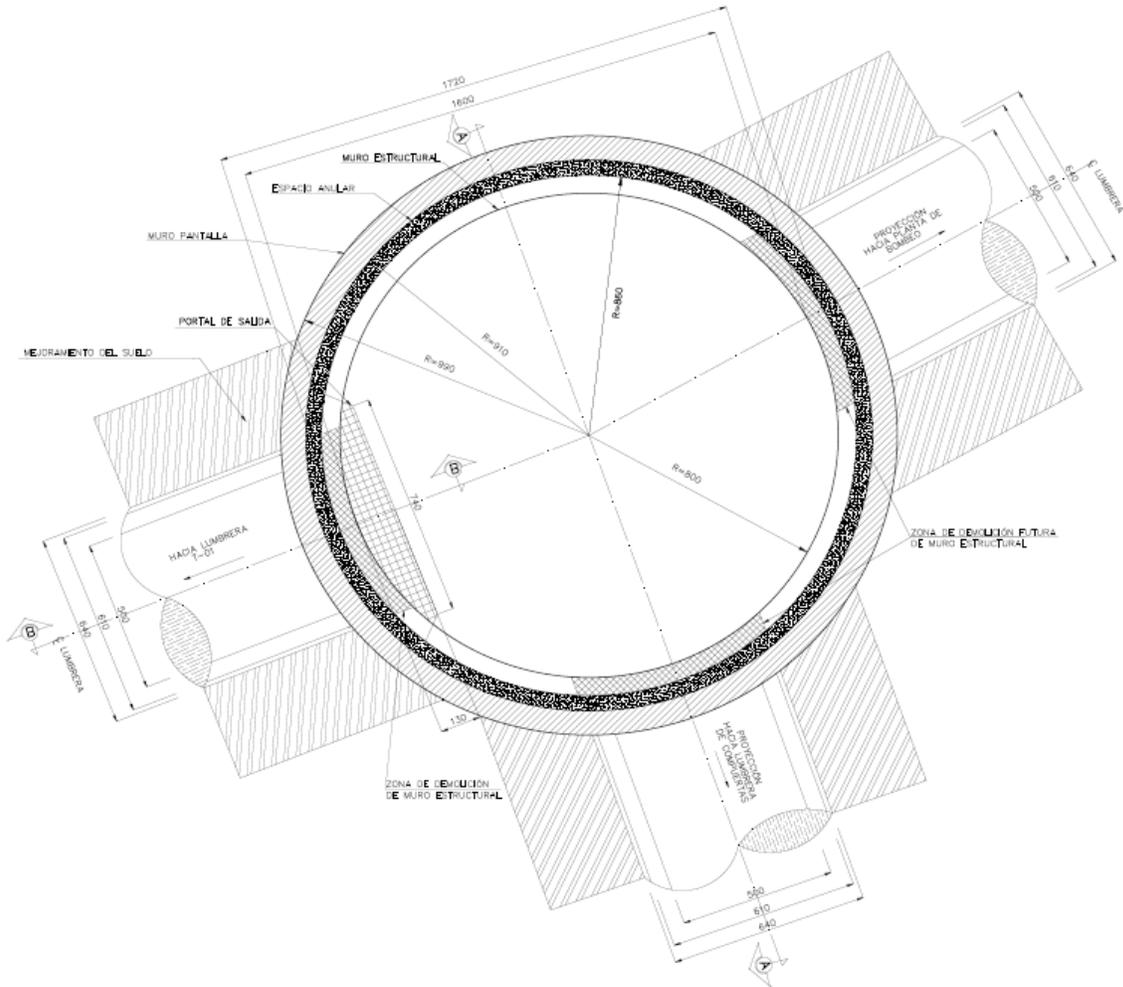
Vista en planta de lumbrera (T-00), con cortes A-A y B-B para portales de entrada/salida.
